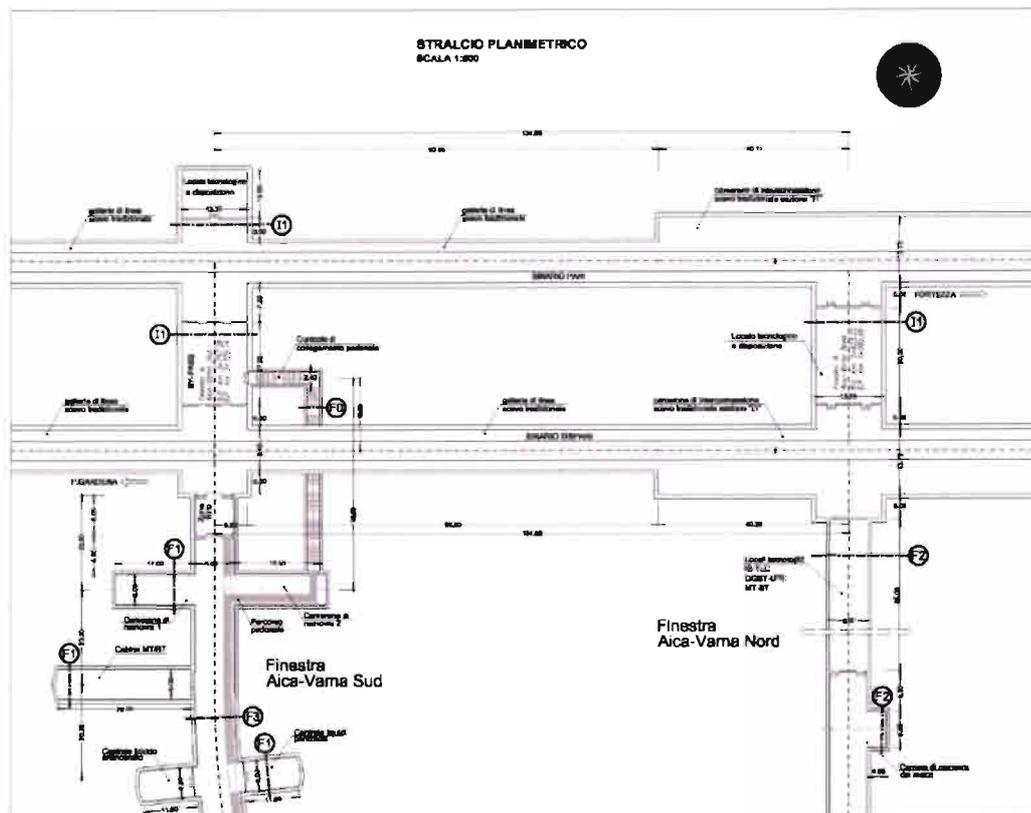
Stralcio planimetrico zona di innesto della finestra Aica-Varna con le gallerie di linea.
